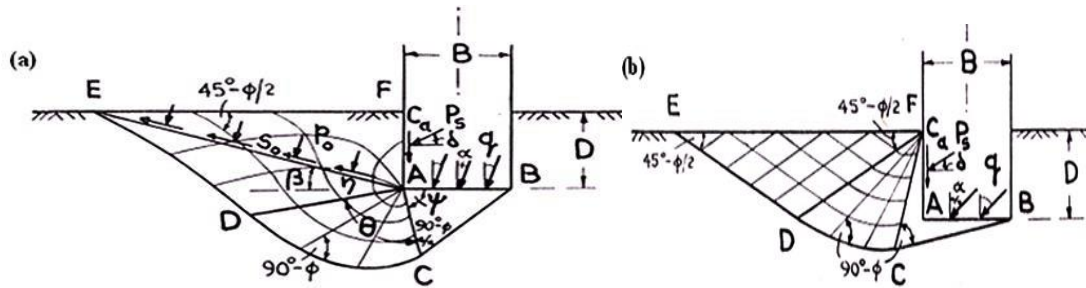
1 Schéma de rupture pour : (a) faible inclinaison (b) grande inclinaison.
